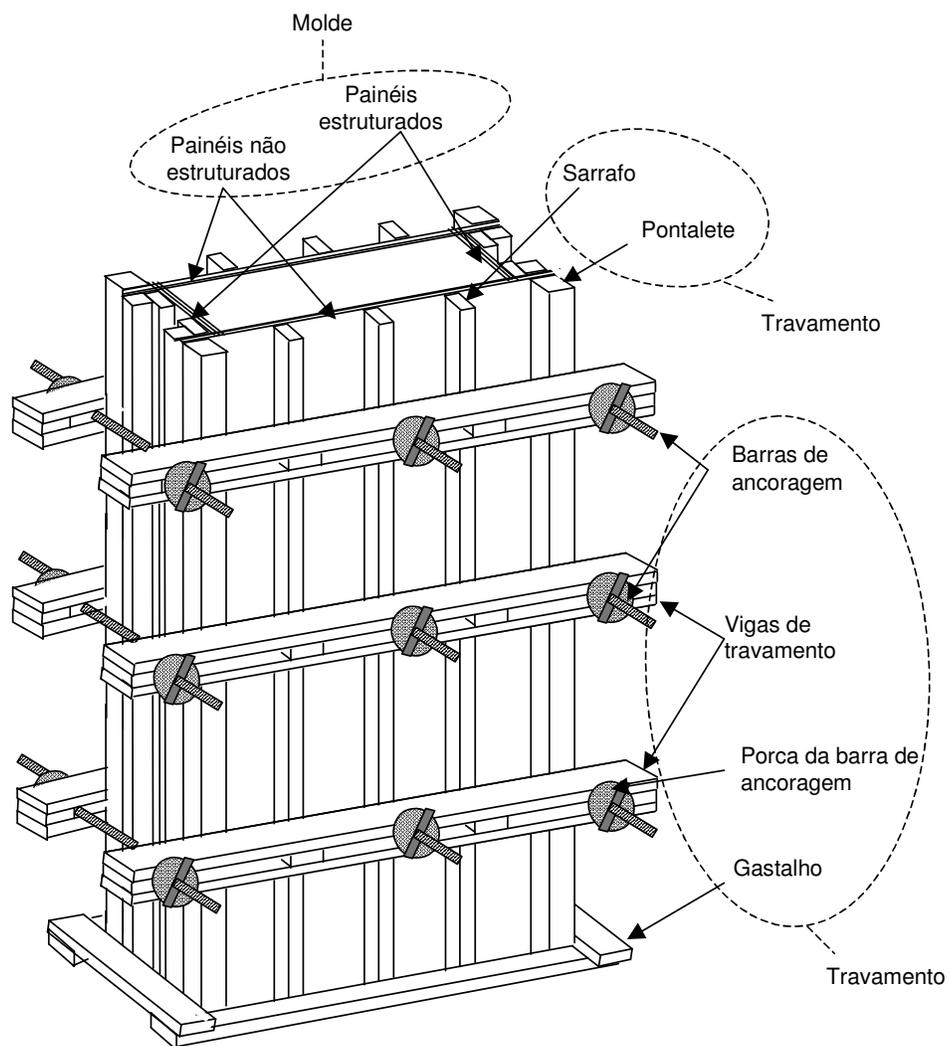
Perspectiva de uma fôrma para pilar com molde formado por painéis estruturados (painéis menores) e não estruturados (painéis maiores) e com travamento constituído por sarrafos, pontaletes, vigas horizontais e barras de ancoragem.
